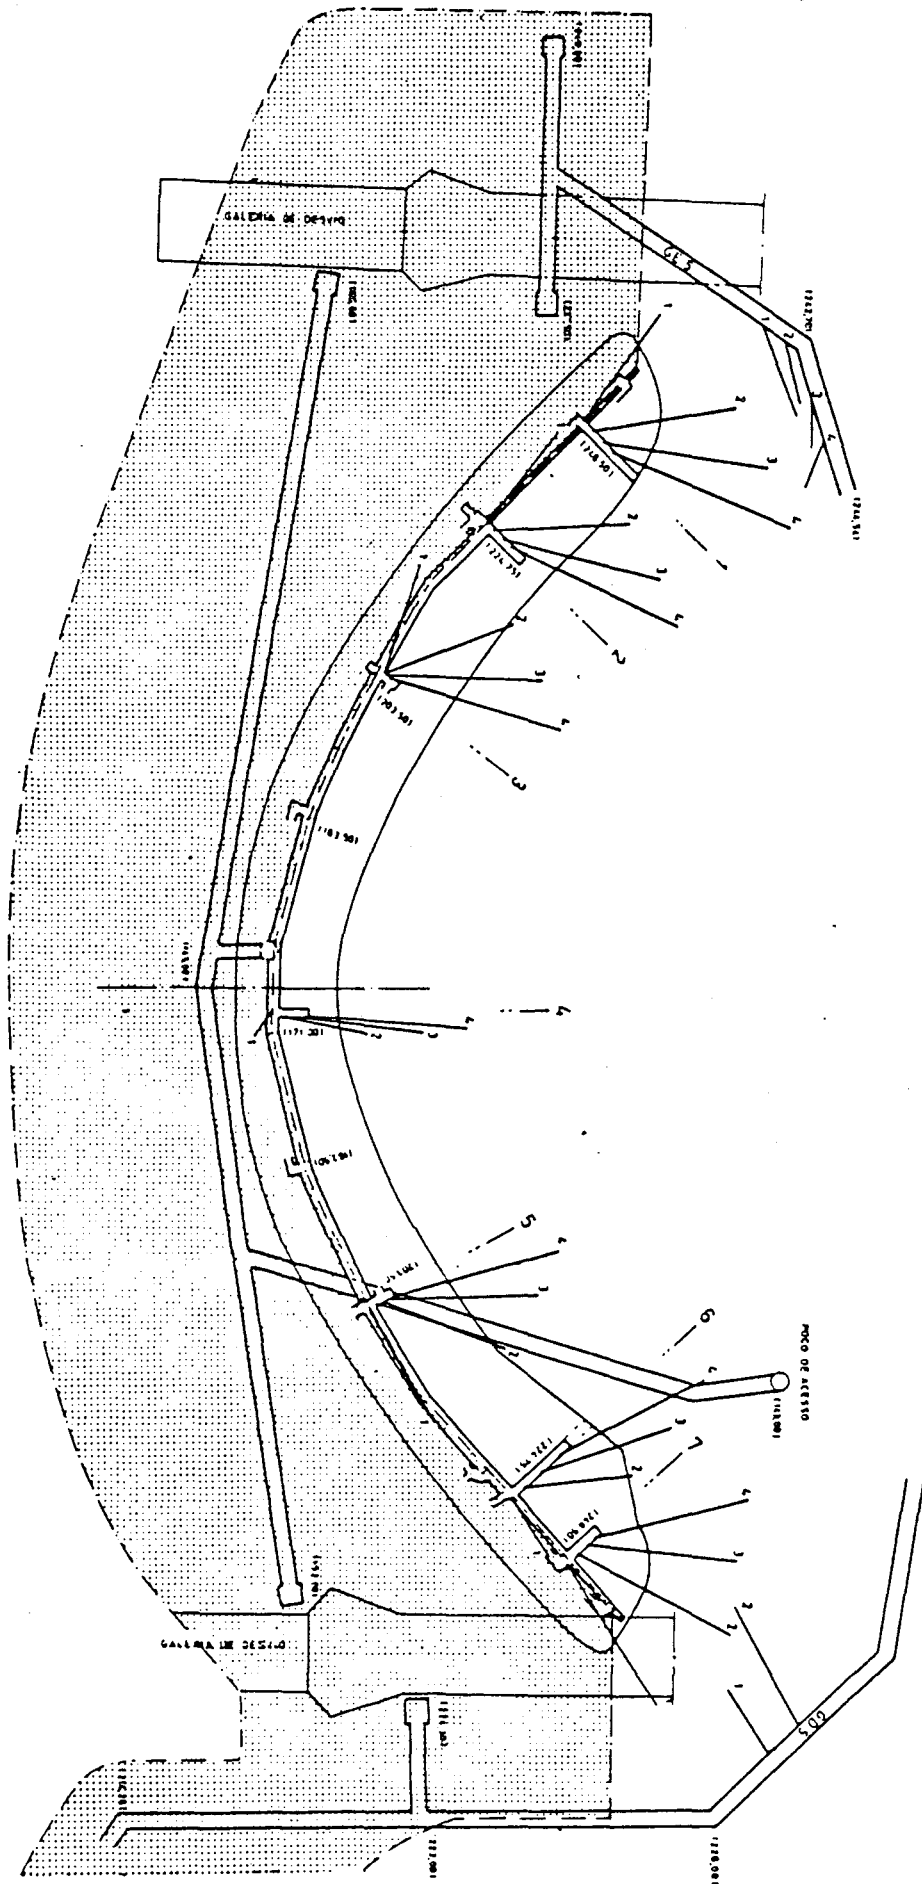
Localização dos leques piezométricos e definição em planta da zona de tratamento da fundação.
